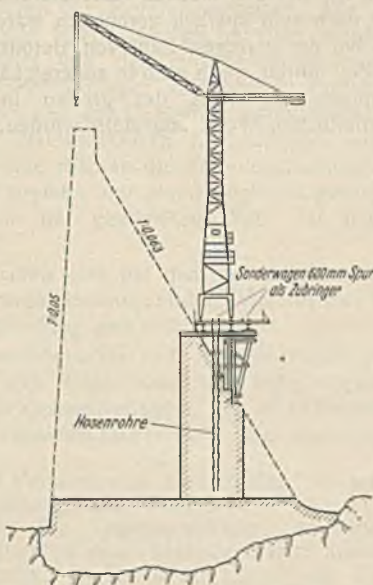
Zillierbachsperre. Betonierbrücke mit Turmdrehkran.
